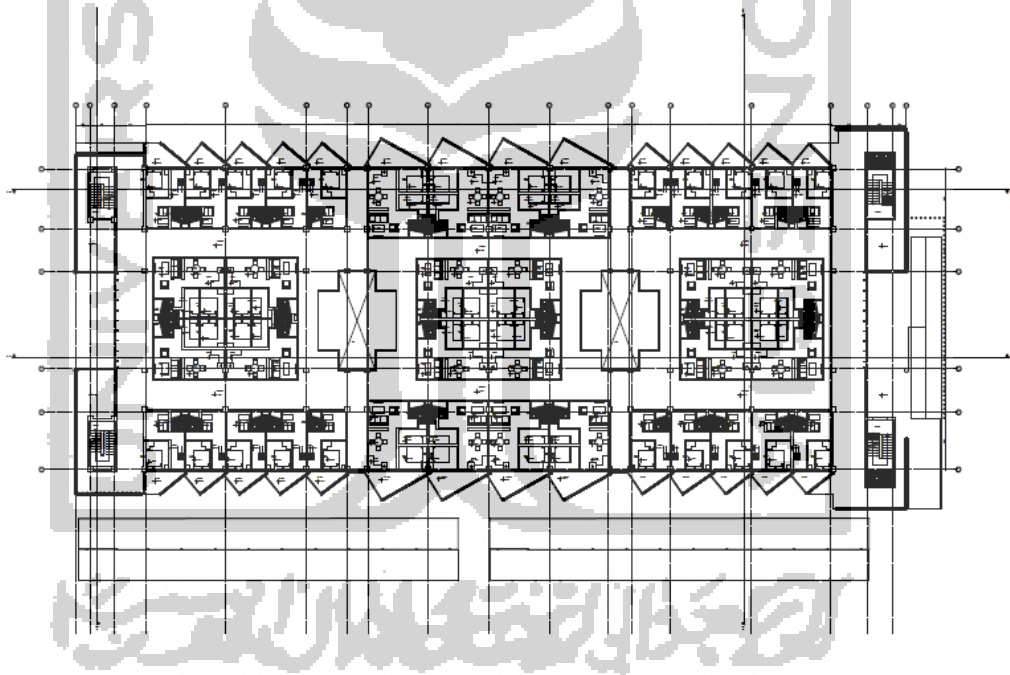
Denah Lantai 1 Sebelum Perbaikan
